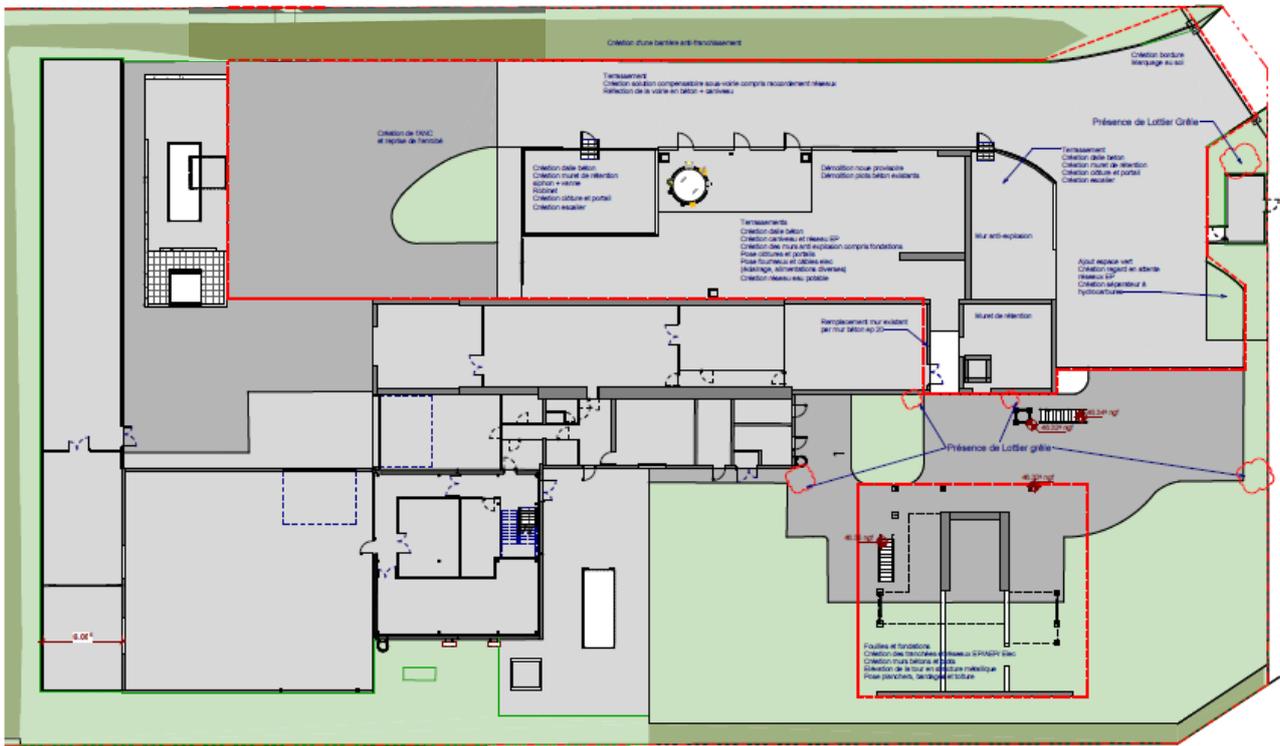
Plan du rez-de-chaussée du zonage des travaux de la 1^{ère} phase (source : TVA Architecte)
